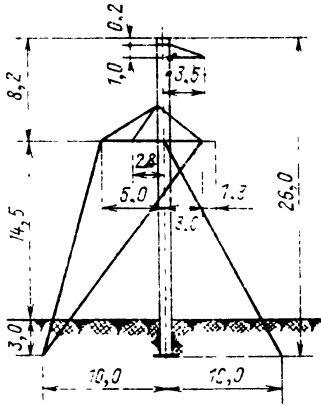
Железобетонная анкерная угловая одноцепная опора на оттяжках ВЛ 220 кВ
